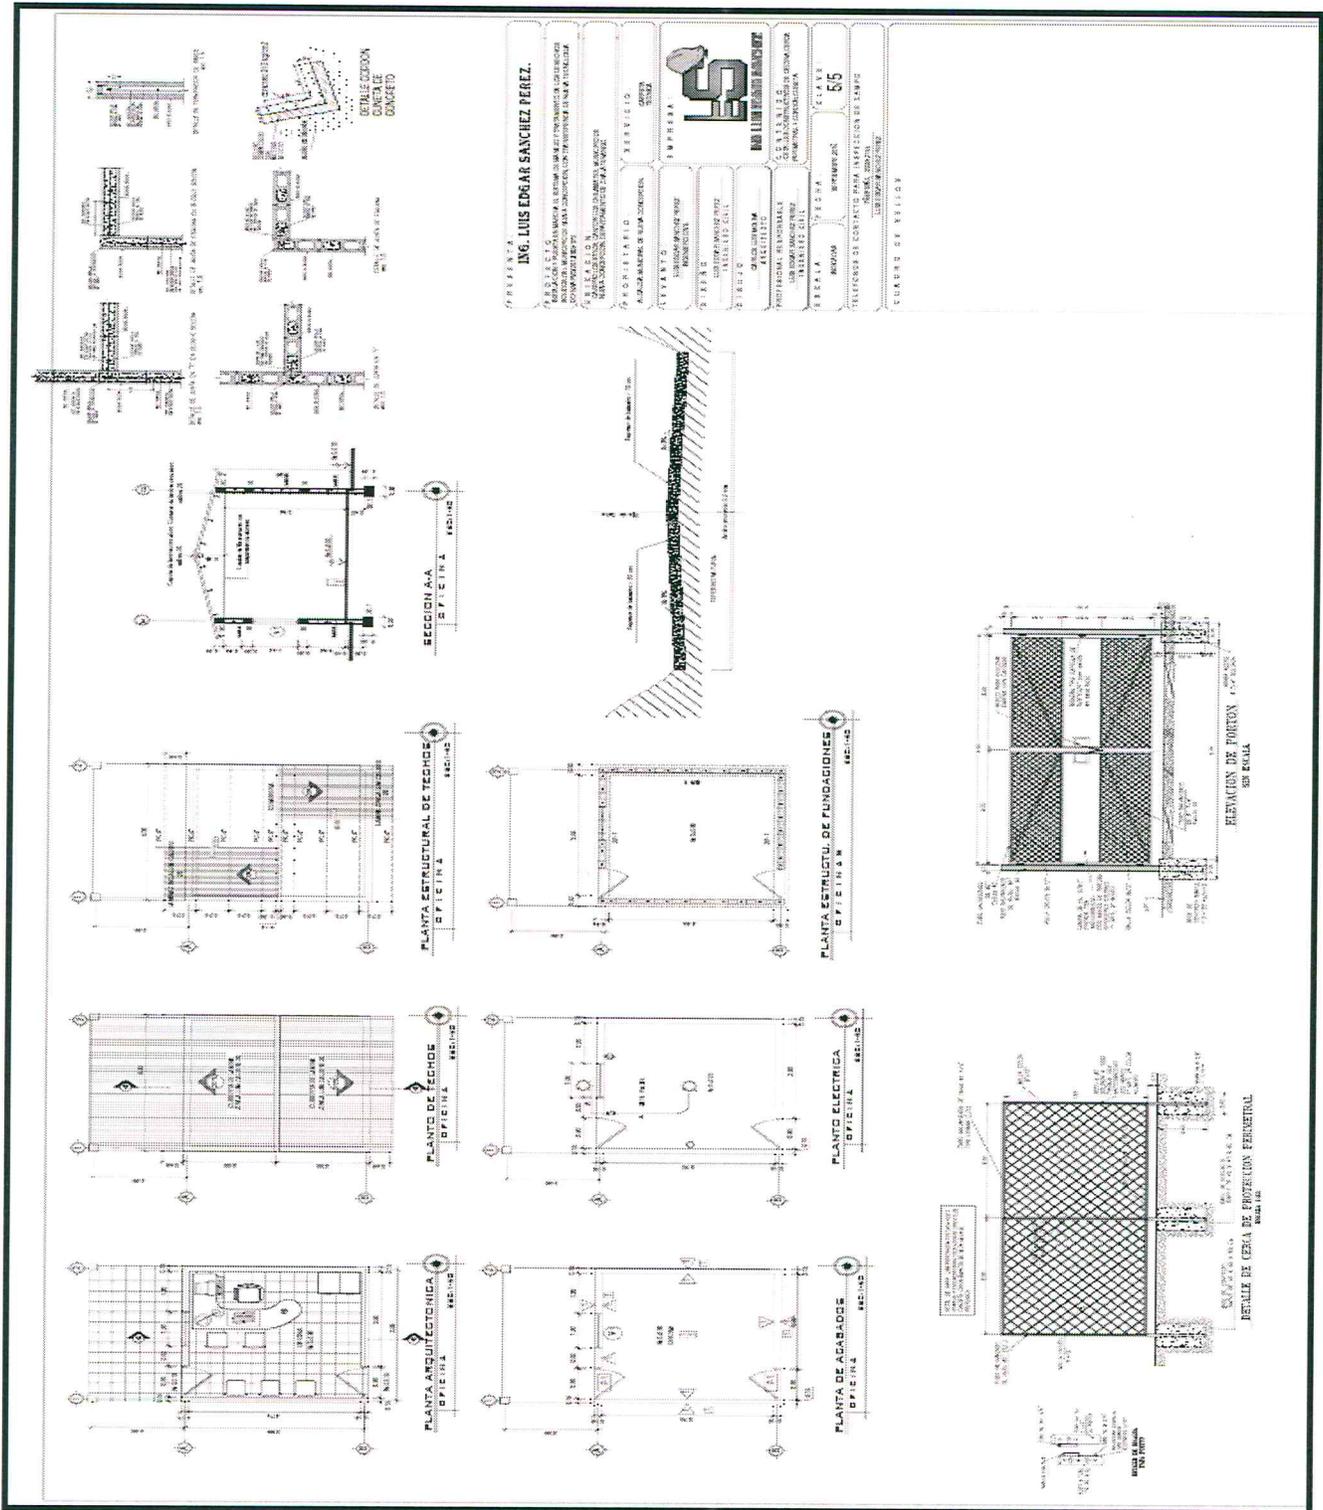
En la imagen se muestra el plano levantamiento de la carpeta técnica.
